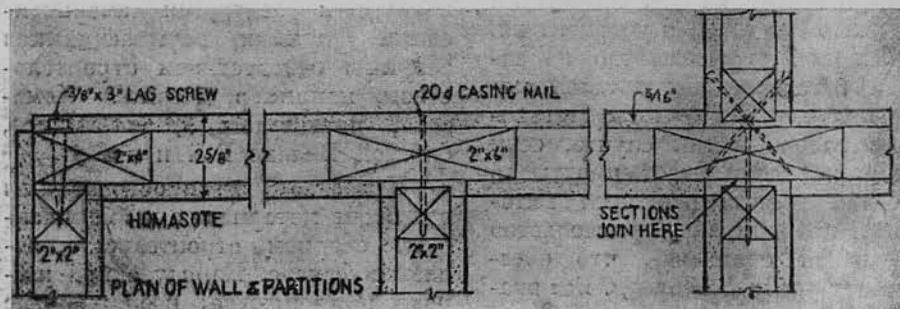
Конструкция стен и перегородок сборного дома «Хомазот»
